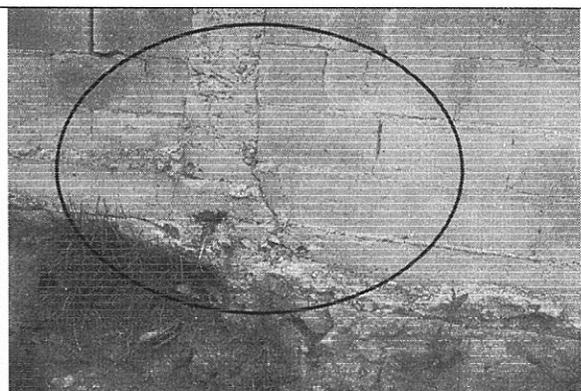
Agrietamiento en la parte inferior del muro en la zona central
